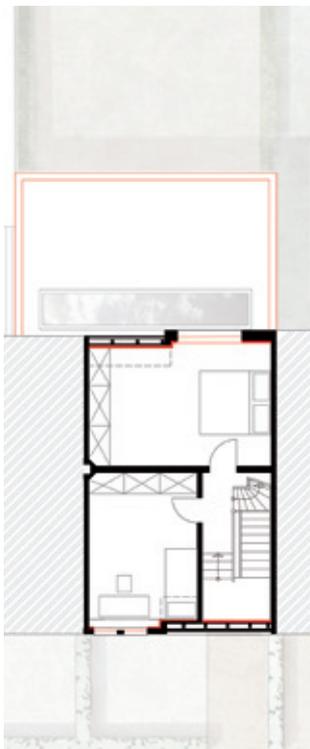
Grundriss 1. Obergeschoss Einzelhaus Variante I
